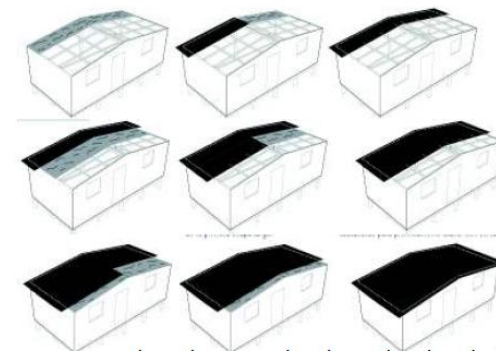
Instalación de Cubierta. Fuente: Manual para la construcción de Un techo para mi País.
